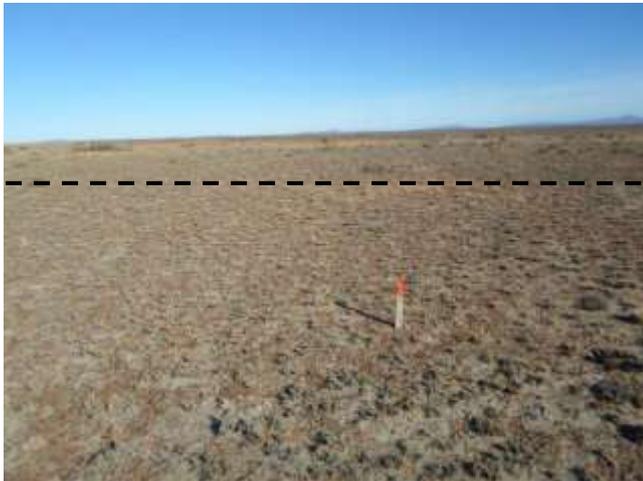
Estaca de señalización observada dentro de los límites de la futura locación de la Colectora Auxiliar. Foto en dirección S y próxima al lateral S de la futura locación.
